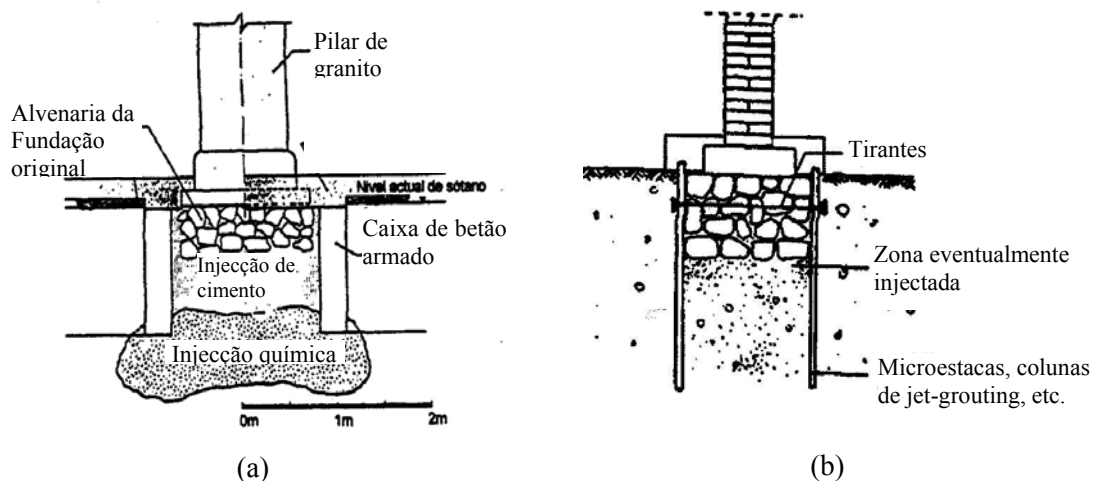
Recalço de fundações, em alvenaria seca ou em estado de desagregação [Rodríguez Ortiz, 2002]: (a) com injeção do solo confinado por paredes-cortina de betão armado; (b) com injeção do solo confinado por cortina de micro-estacas, jet-grouting, etc.
